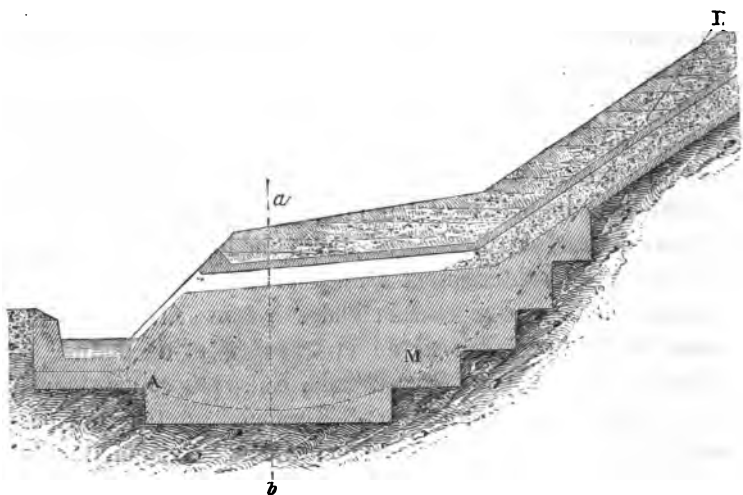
Rigole transversale sur un mur en maçonnerie.
